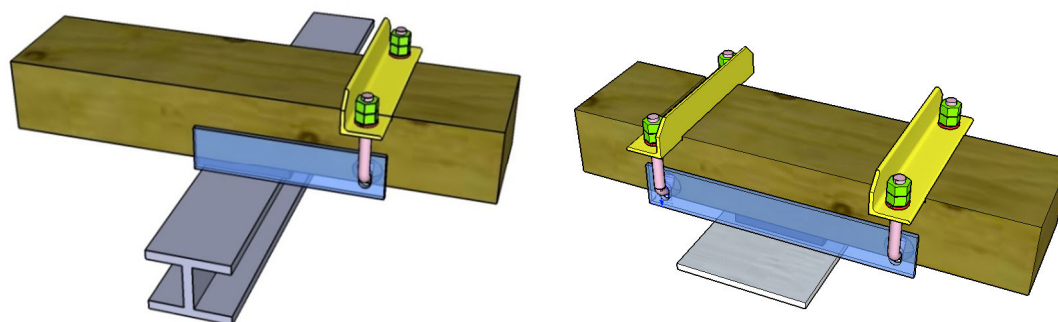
Esquema do sistema de fixação das travessas em obra
